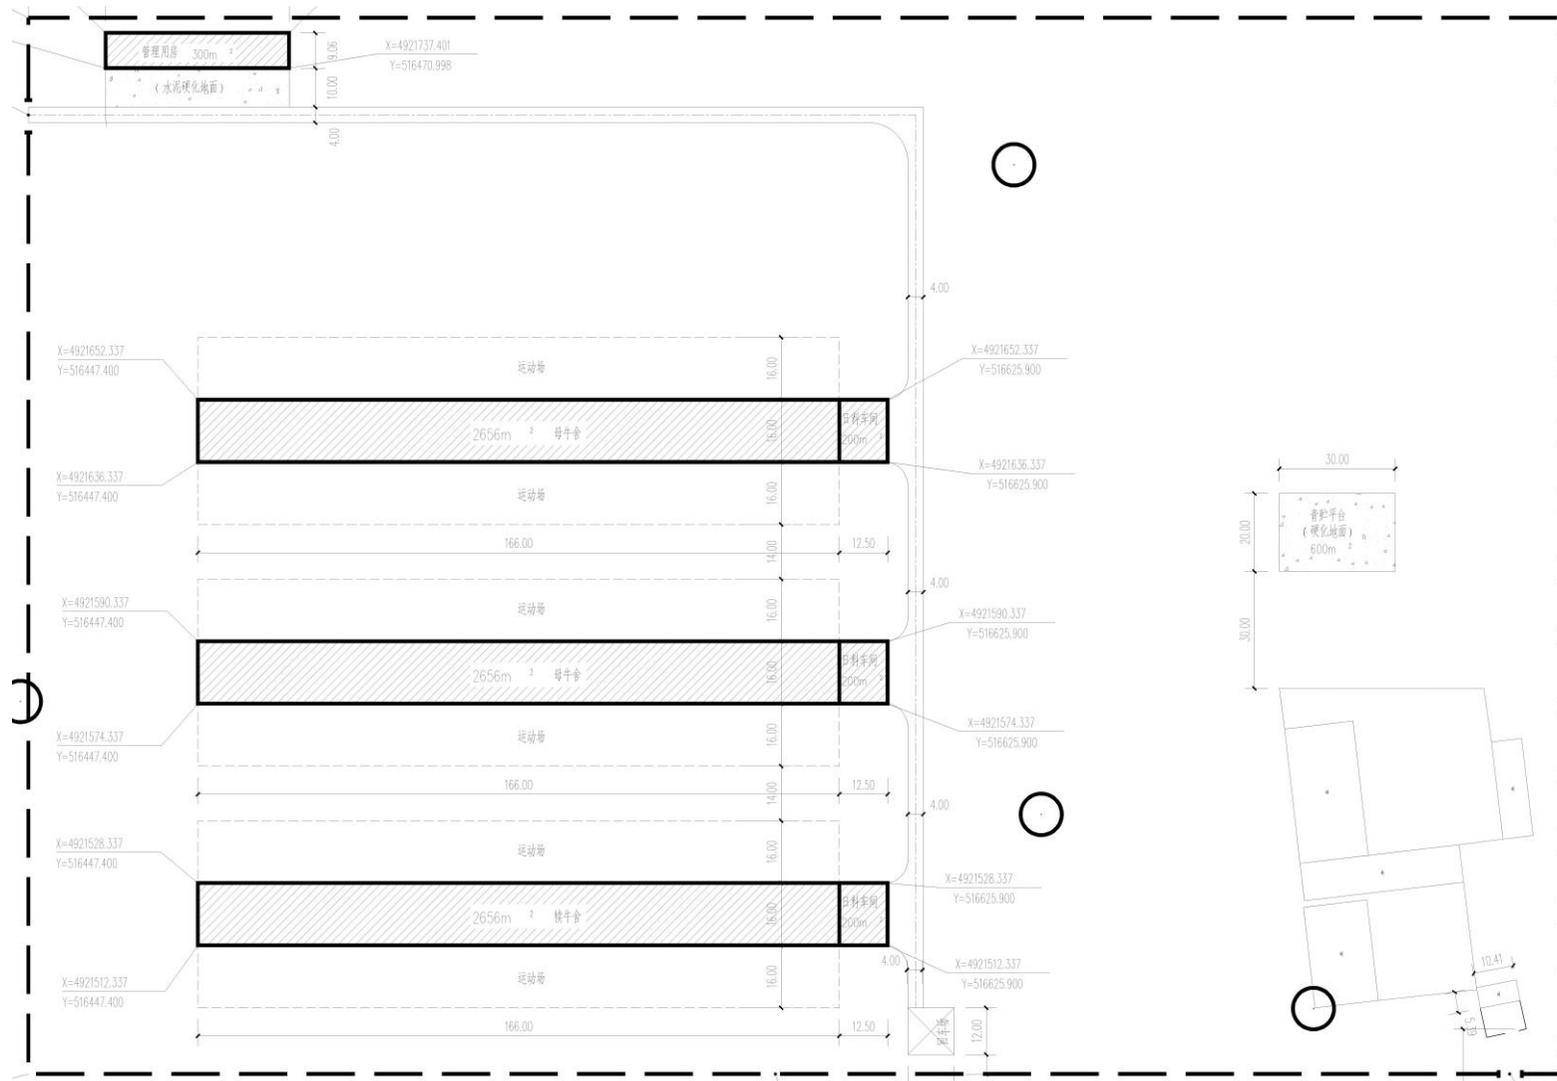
(1) 呼日勒图养殖区平面布置图
